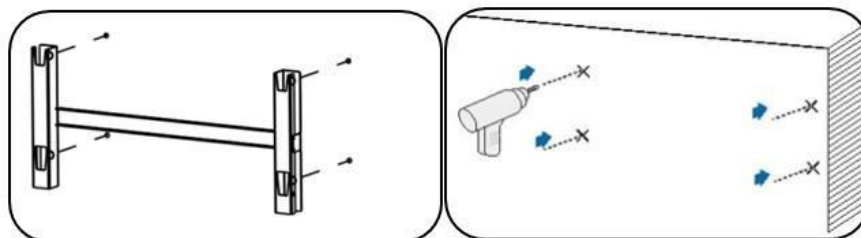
Trapanatura dei fori sulla parete di montaggio
